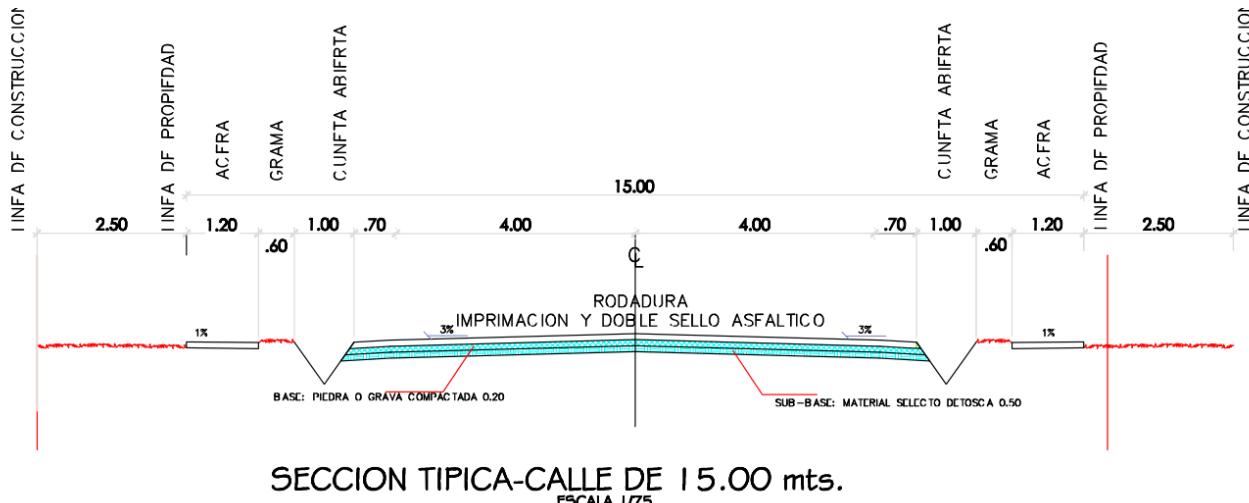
Esquema de las calles de 15 m. (Fuente: Anteproyecto)
